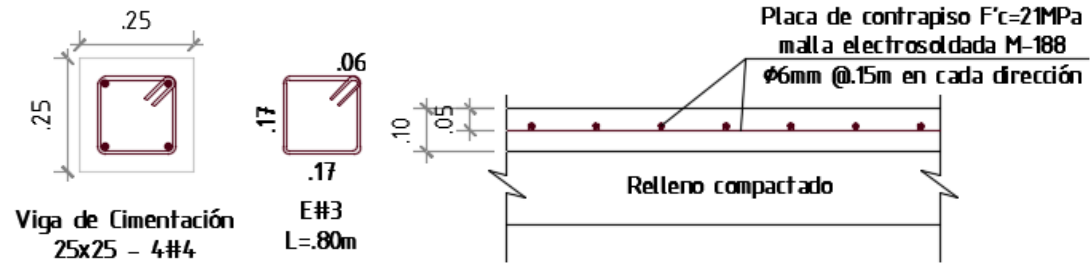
Refuerzo de vigas de cimentación (izq.) y placa de contrapiso (der.)
